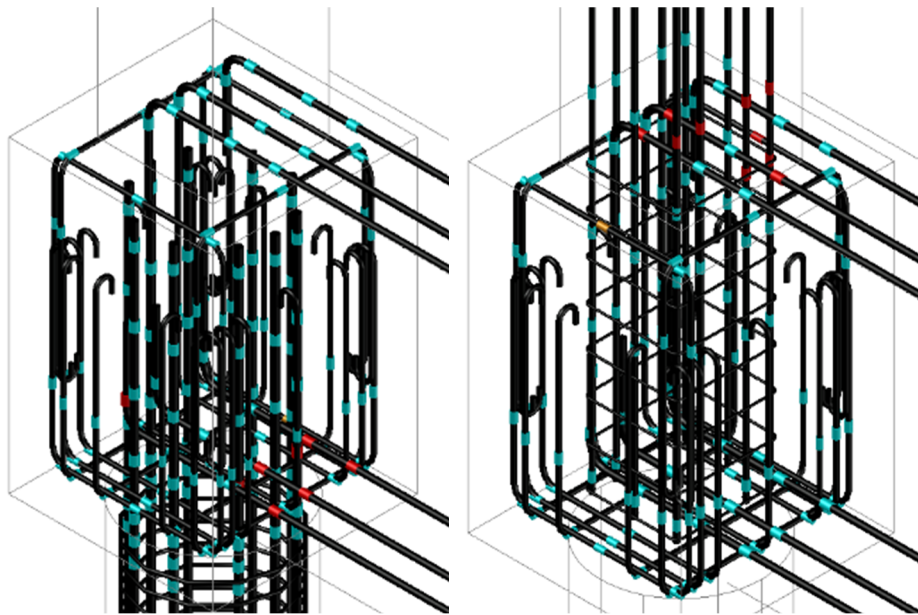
試験体 E-2 降伏ゲージ位置（降伏した部材のみ表示 左：正 右：負）
